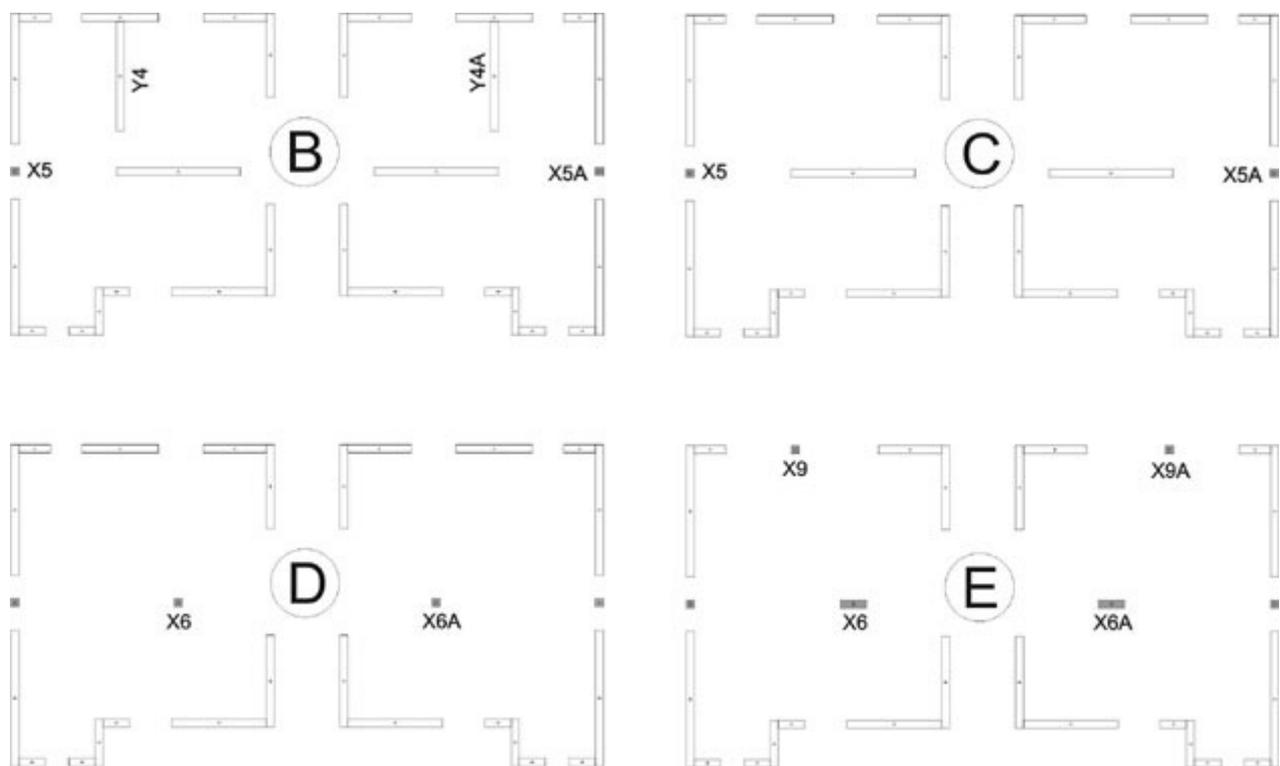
Pianta in struttura mista alternative, ottenute a partire dalla pianta tipo (configurazione A).
